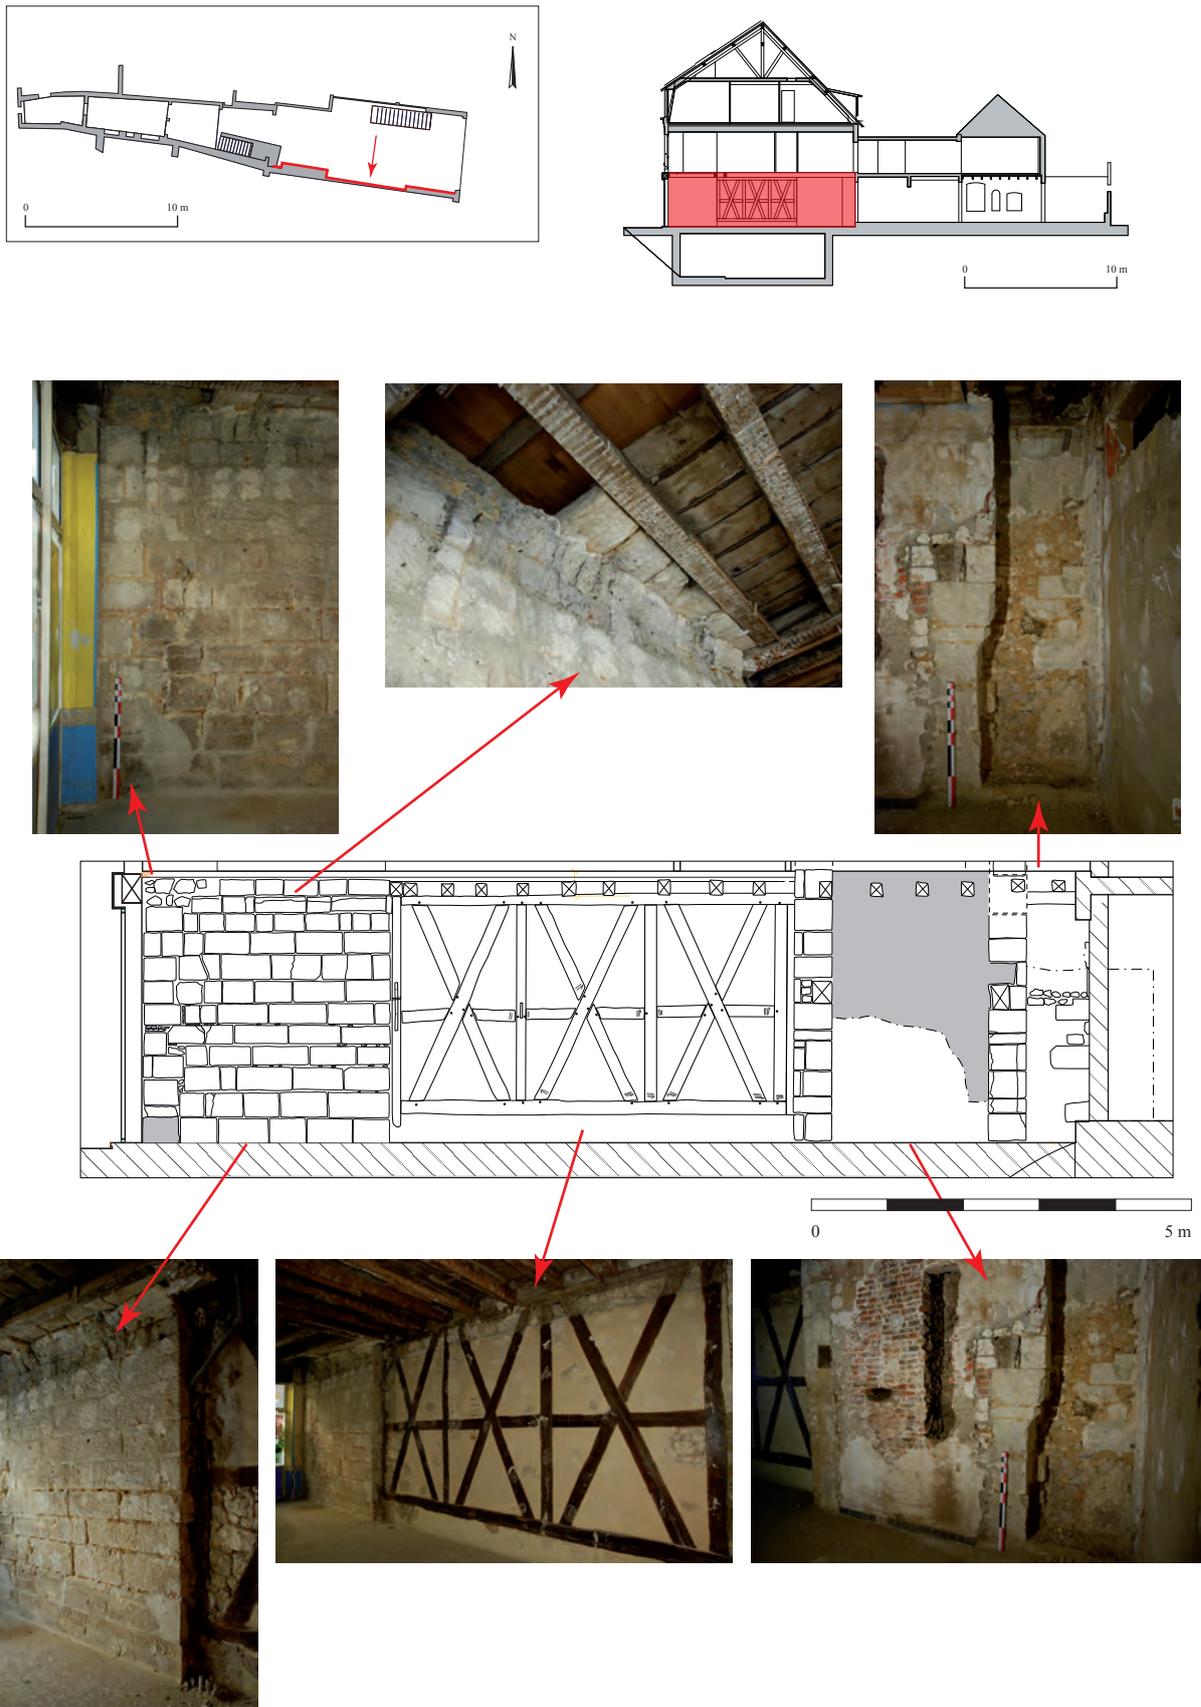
Élévation du mur sud au niveau du rez-de-chaussée avec localisation des clichés photographiques.
